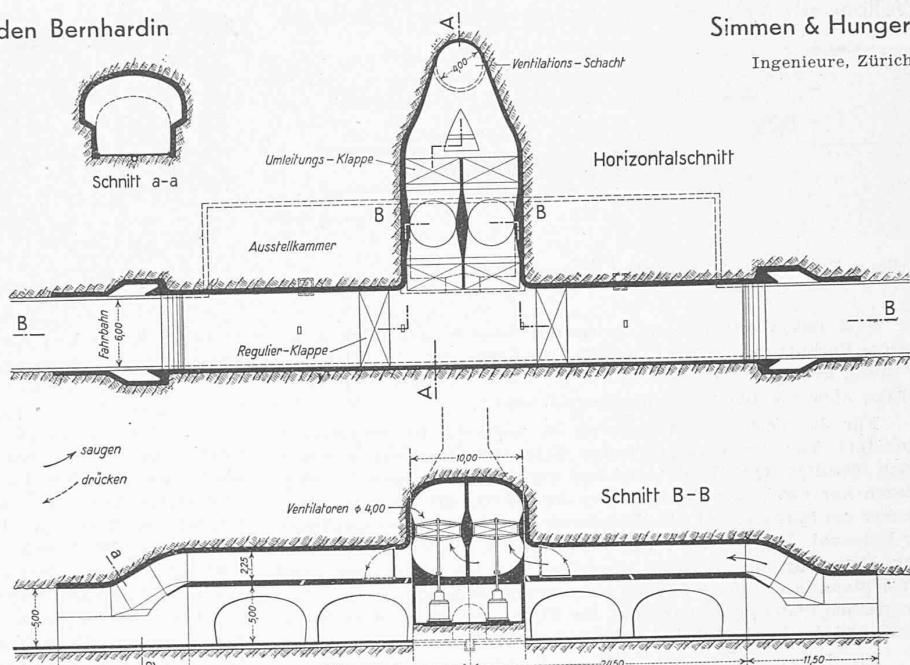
Längs- und Querschnitte der Ventilationsanlage mit Schacht in Tunnelmitte, 1:600
